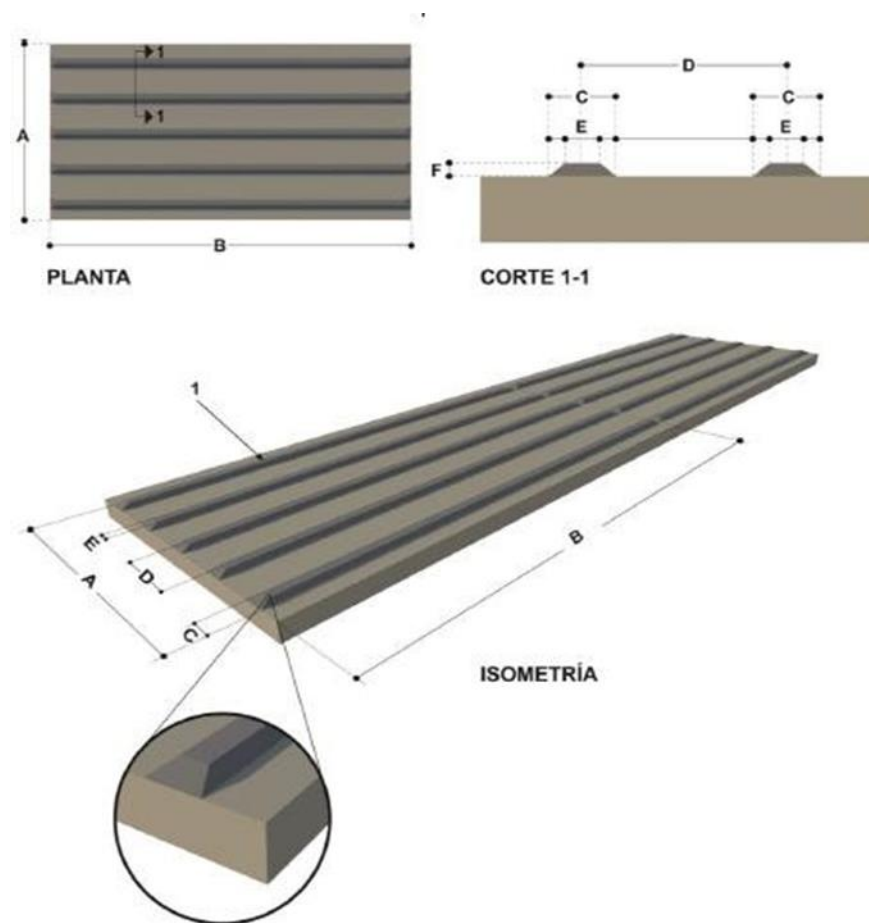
Patrón de alto relieve trapezoidal continuo
